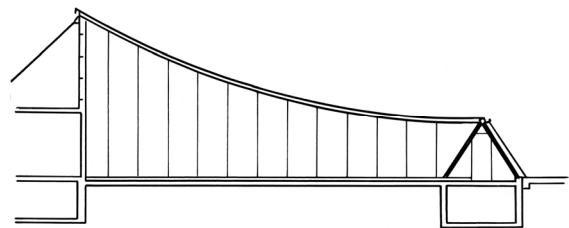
Hängedächer mit großem Dachlängsgefälle, Dachentwässerung über den Tiefpunkt am Auflagerrand
